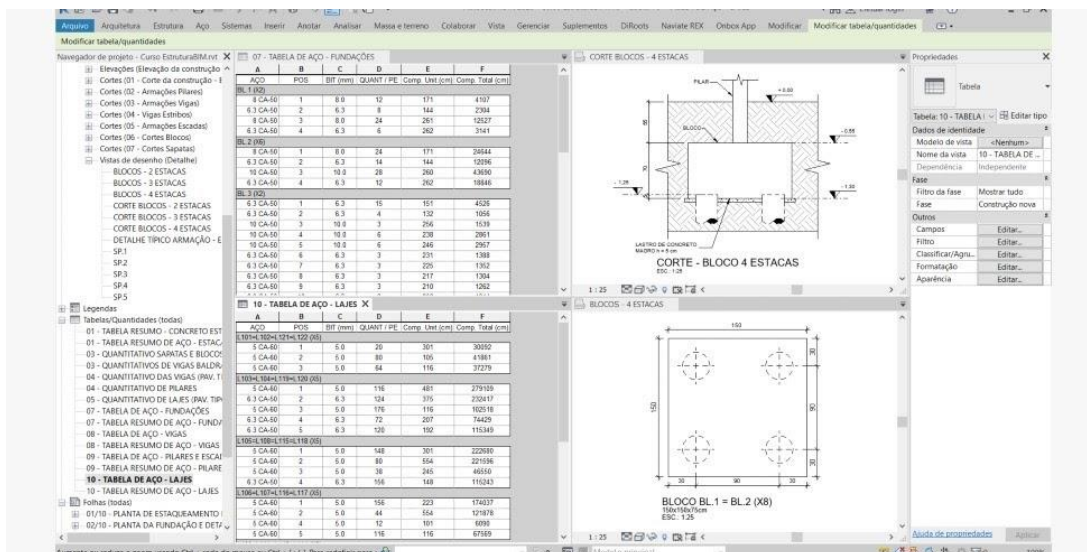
Detalhamento de Projeto estrutural produzido no Revit
